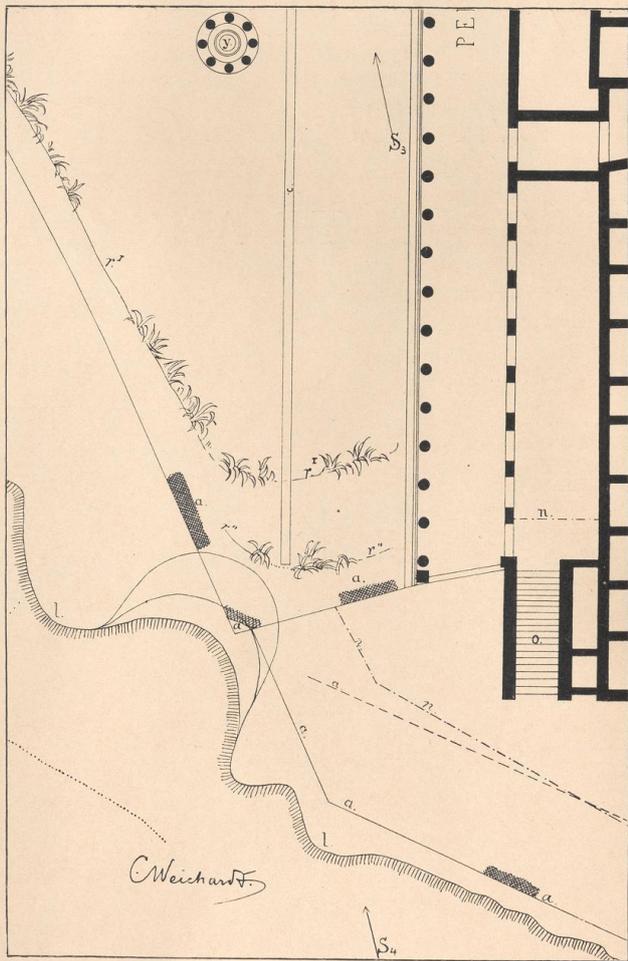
Grundriss zur Süd-Ostecke des forum triangulare.
